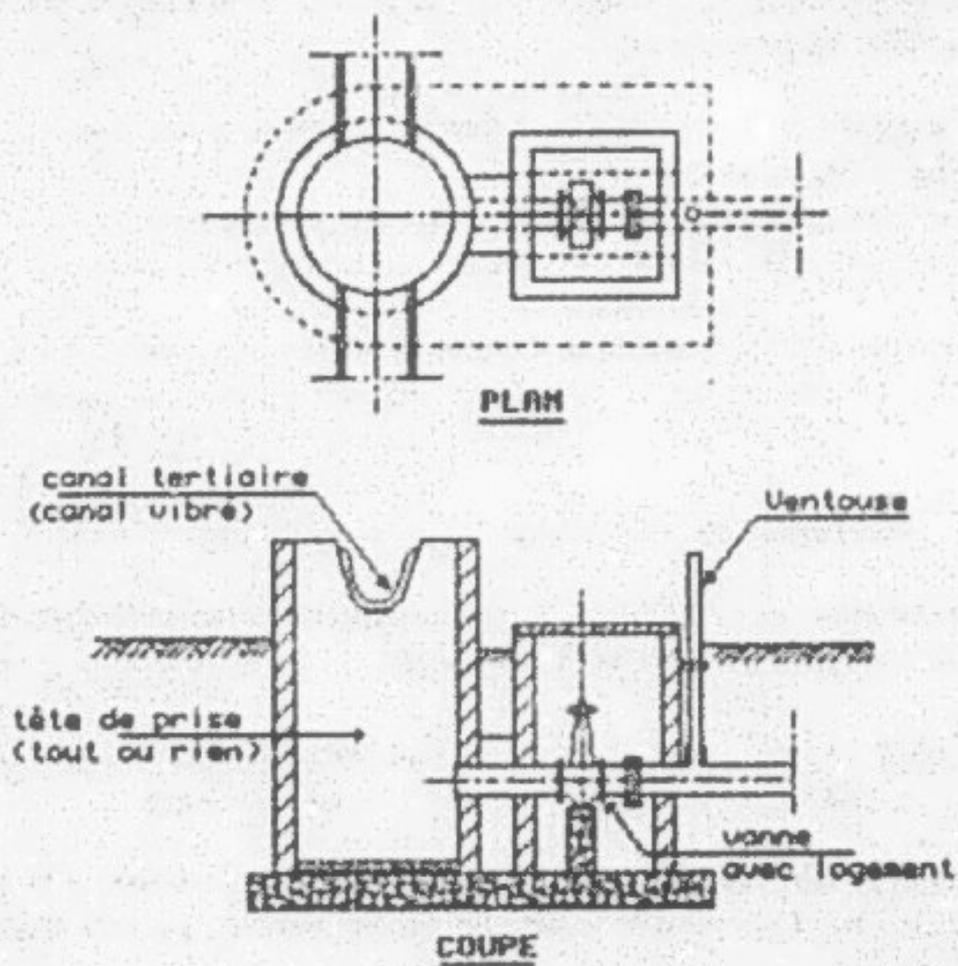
Prise sur canal tertiaire avec vanne de sectionnement
